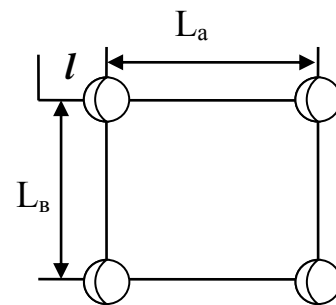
Выбор расположения светильников в плане помещения
